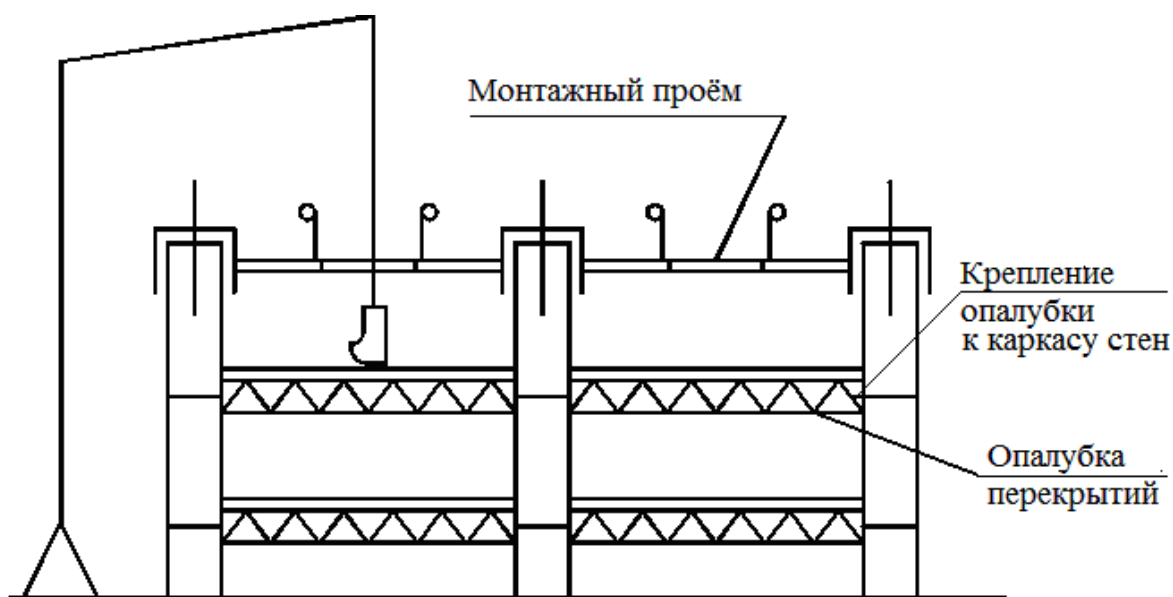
Бетонирование перекрытий одновременно с возведением стен
